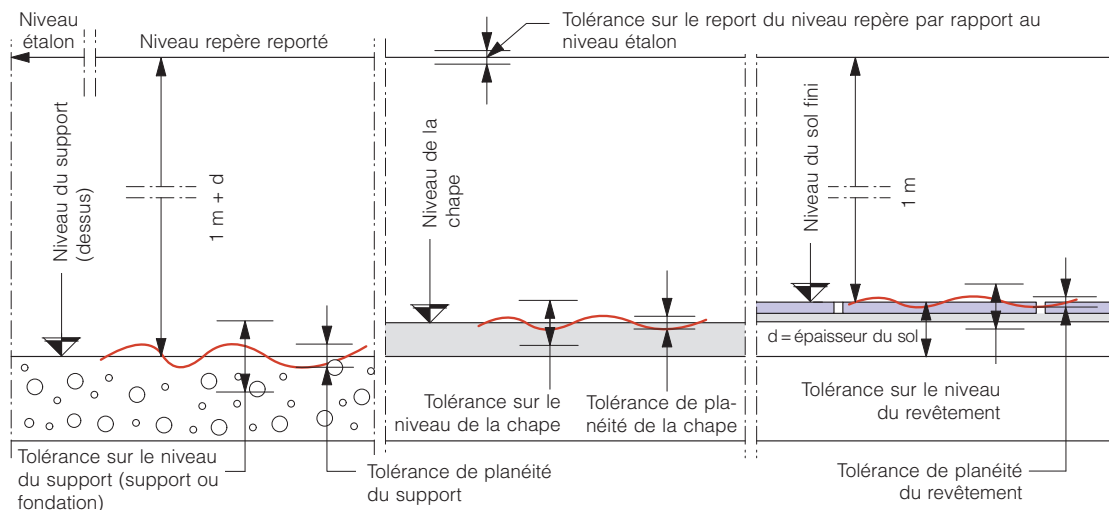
Différence entre les tolérances sur le niveau et sur la planéité.
